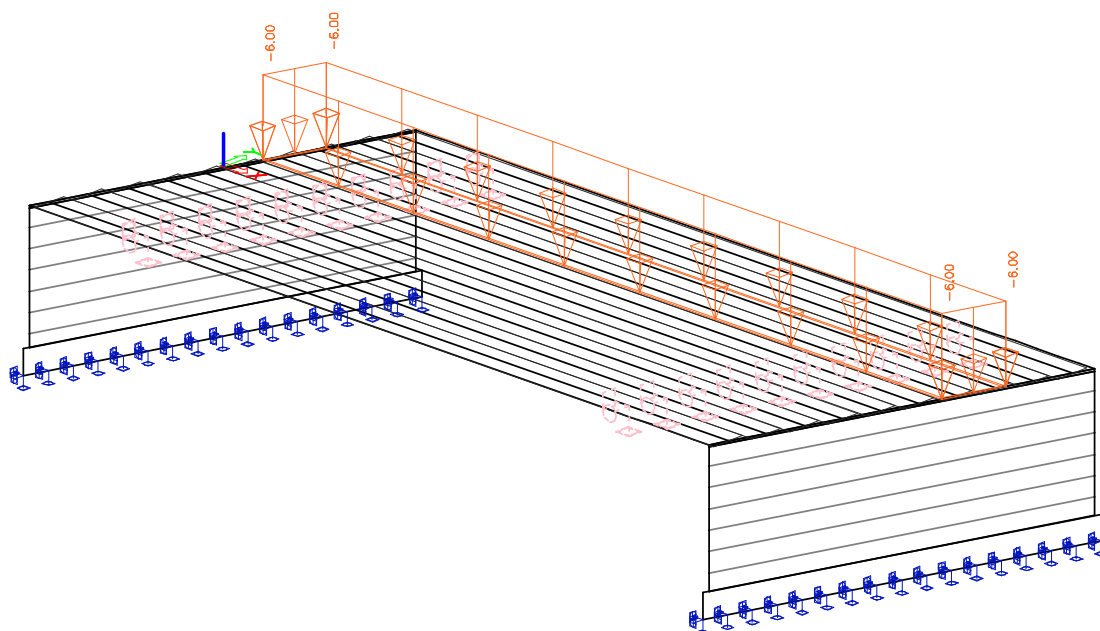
Zatížení dopravou – LM1 – TS2
